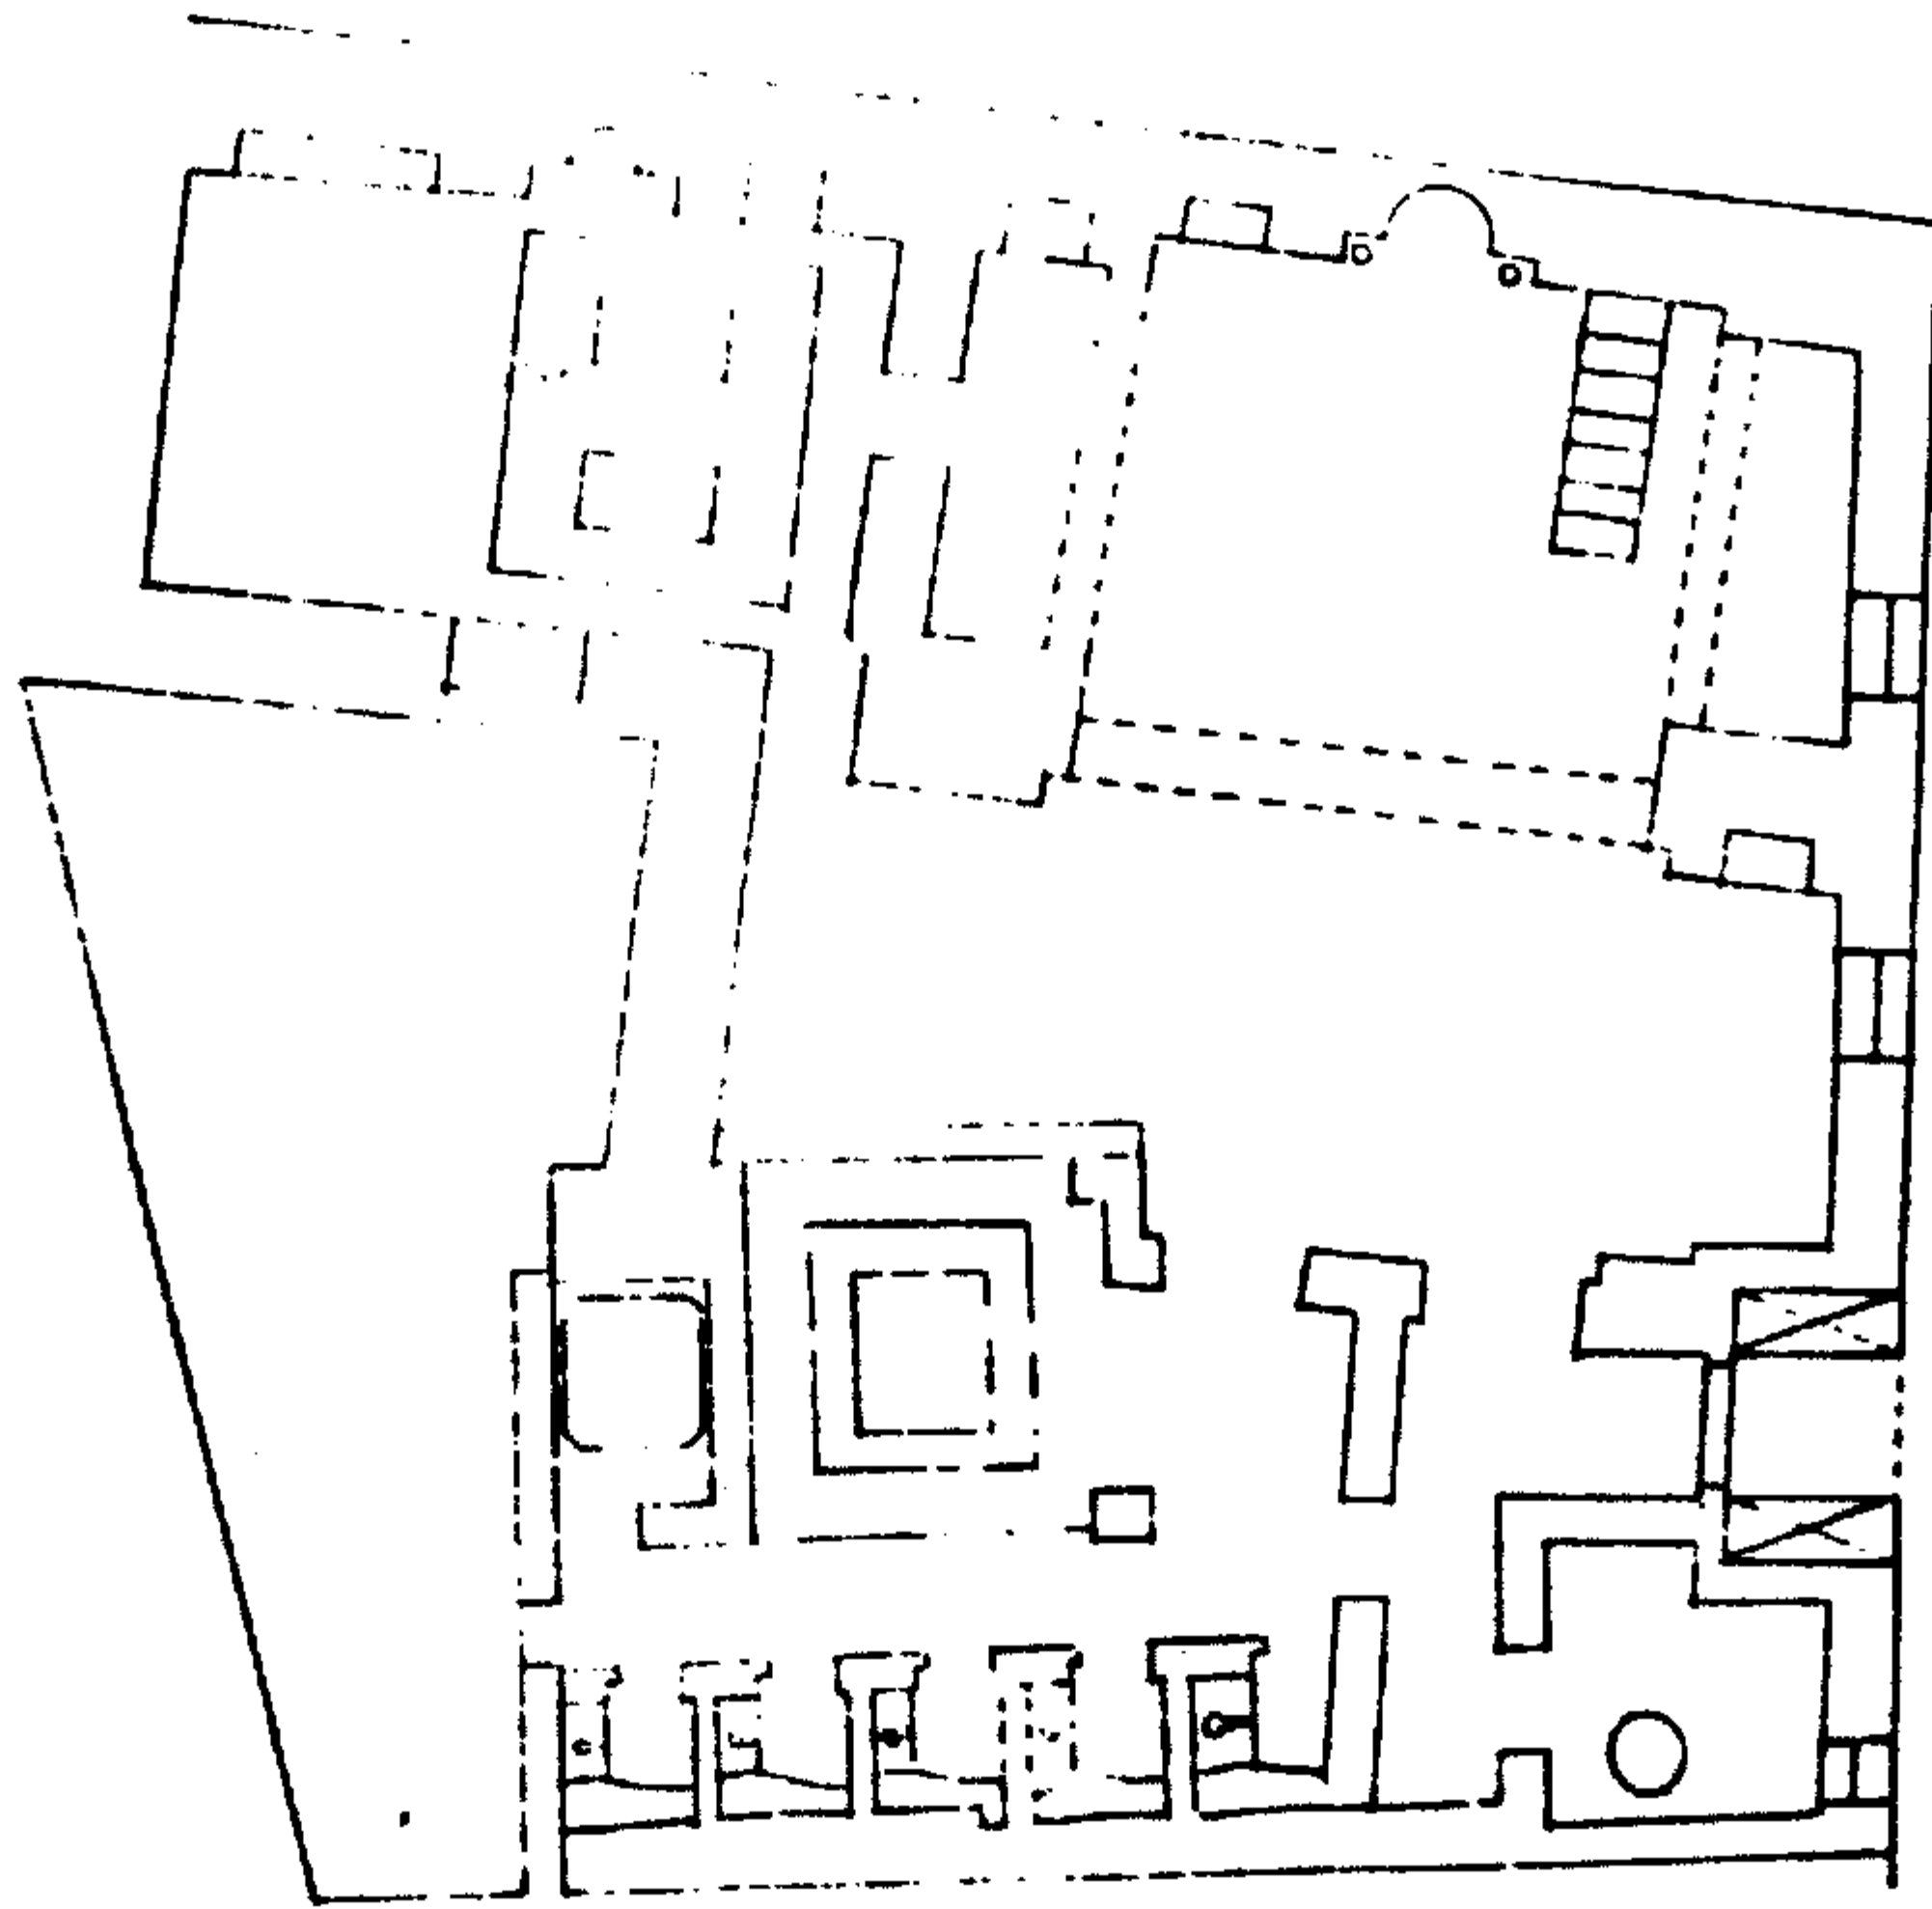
مسقط أفقي لمدرسة ايتمش البجاسي بالقاهرة.
